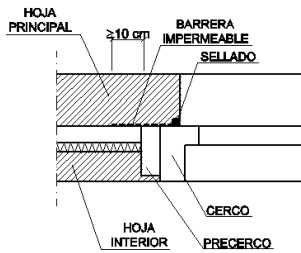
Ejemplo de encuentro de la fachada con la carpintería
